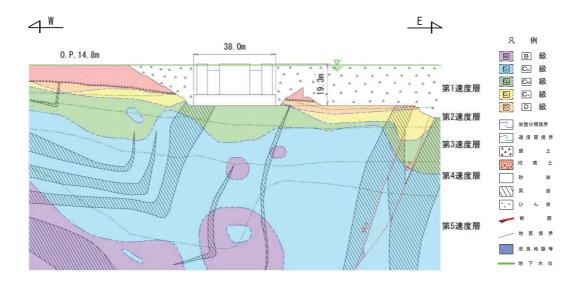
排気筒基礎 地震時荷重算出用地質断面図 (EW 断面)
